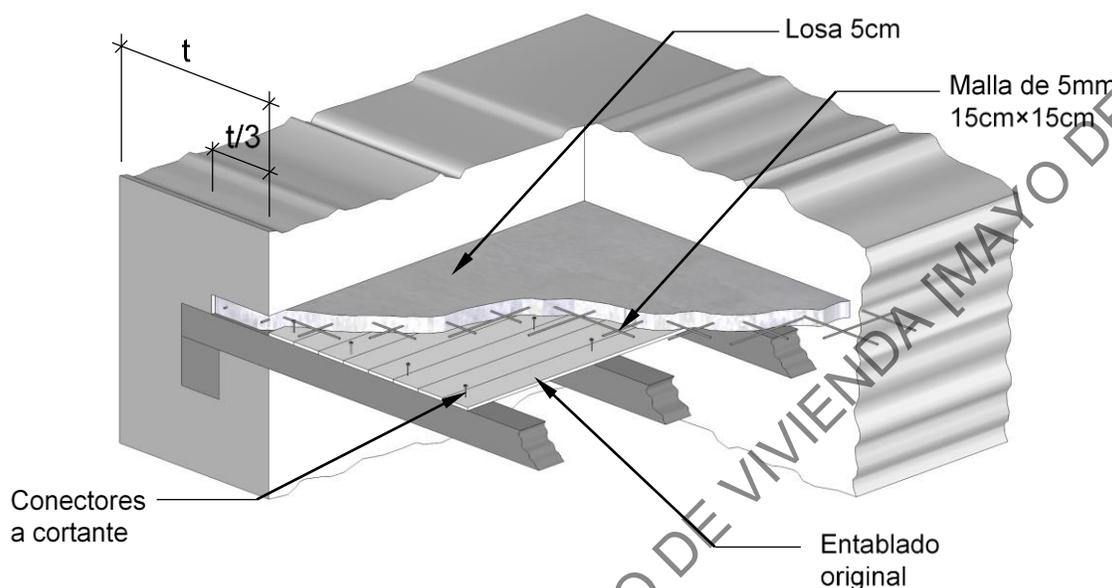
Reforzamiento de diafragma mediante construcción de plaqueta de concreto
